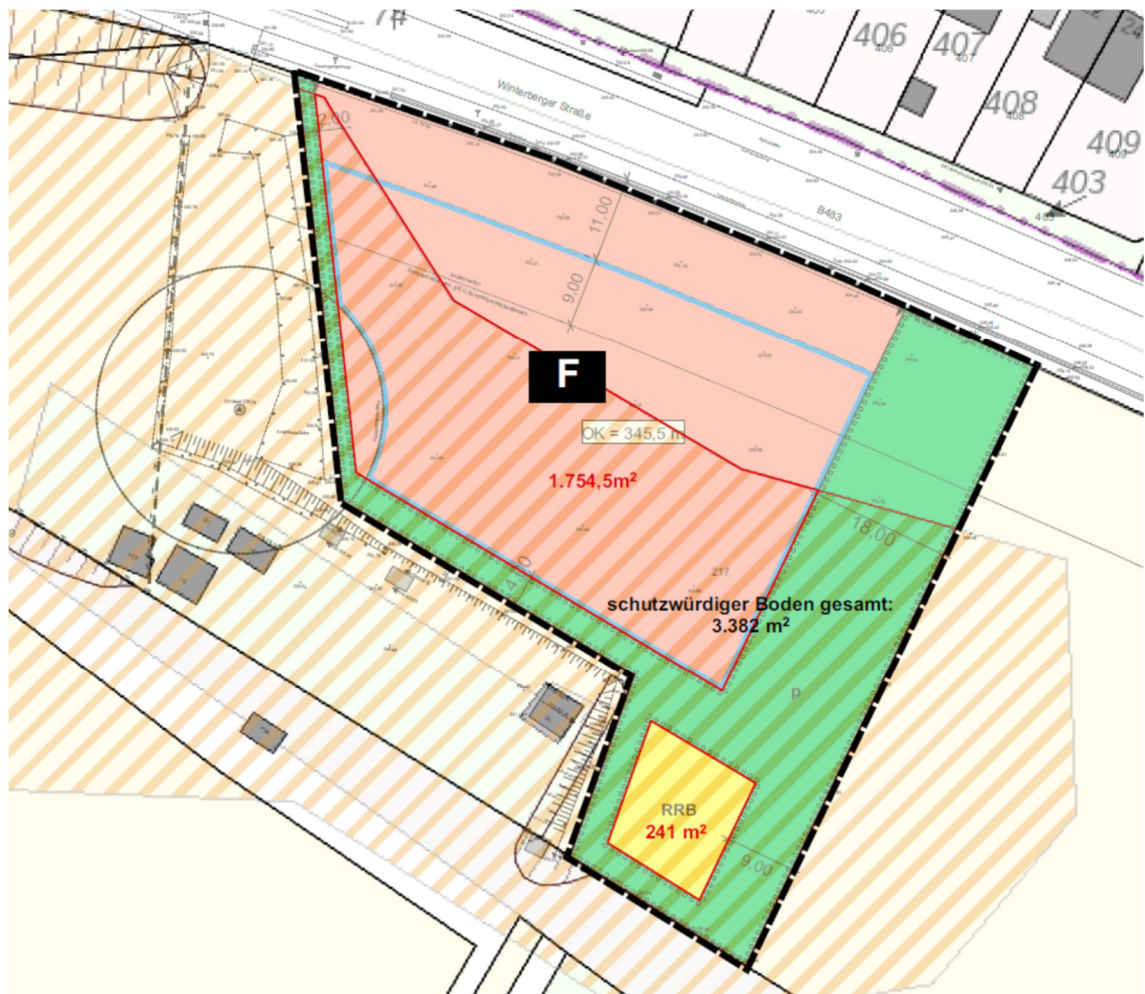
Versiegelung (rot umrandet) des schutzwürdigen Bodens (schraffiert) innerhalb des Bebauungsplans
